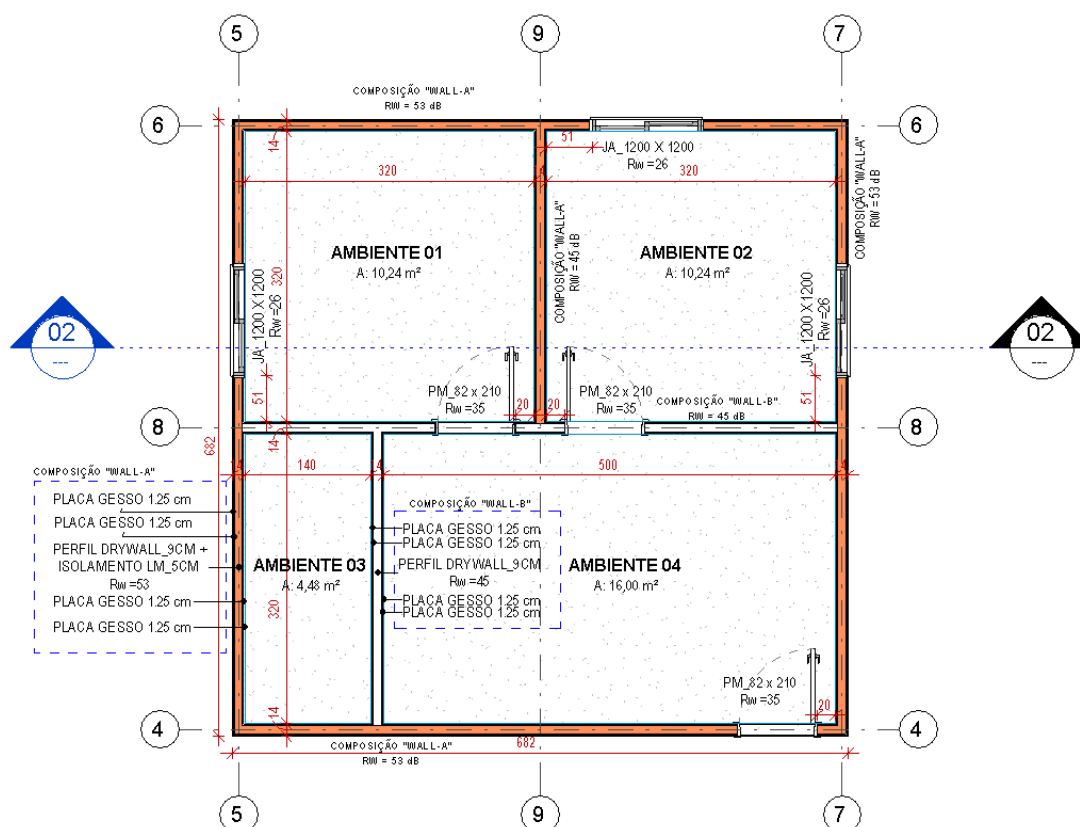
Planta baixa do Protótipo 02 com a identificação dos elementos construtivos. Fonte: Autor.
